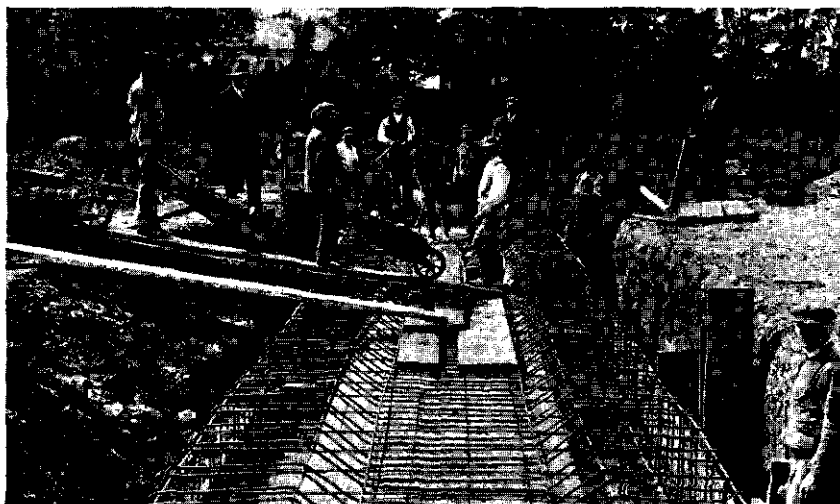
Betonowy przepust płytowy w pow. Wejherowskim.
